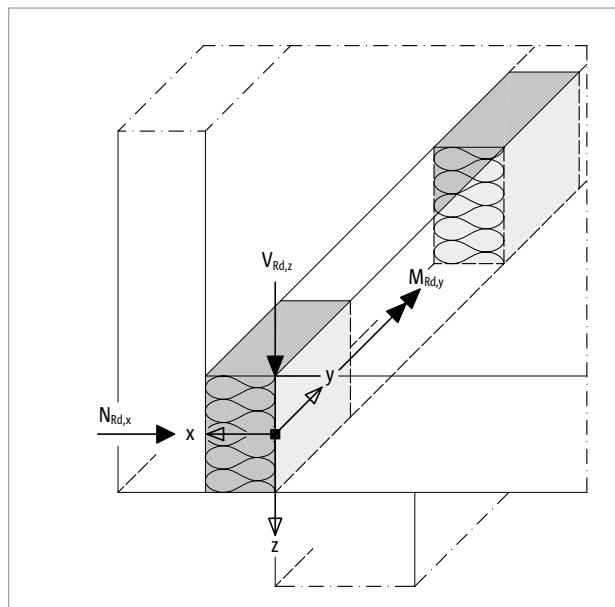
Schöck Isokorb® XT tipo AP: regola dei segni per il calcolo dei parapetti anteposti
